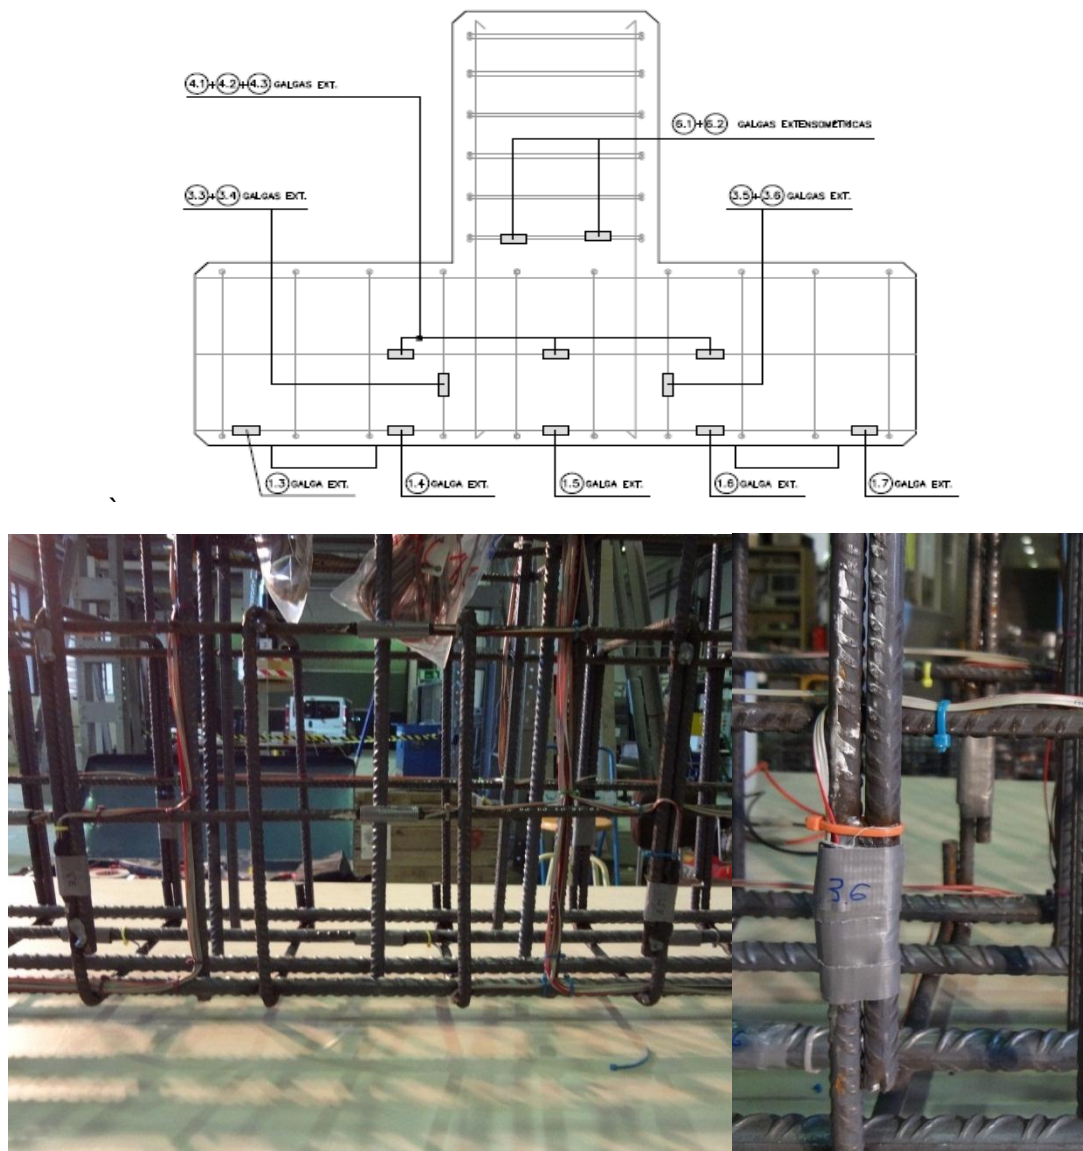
Encepado AB1_1, donde se muestran las Galgas adheridas a la barra de acero,
